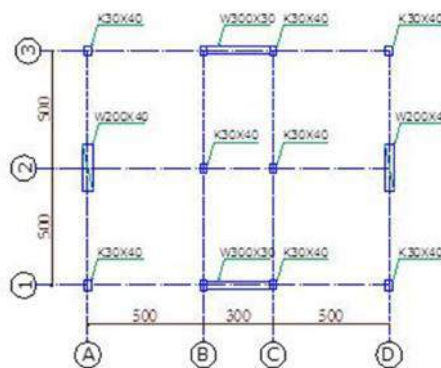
24: Planimetria e strukturës së përforcuar me muret e reja beton arme
